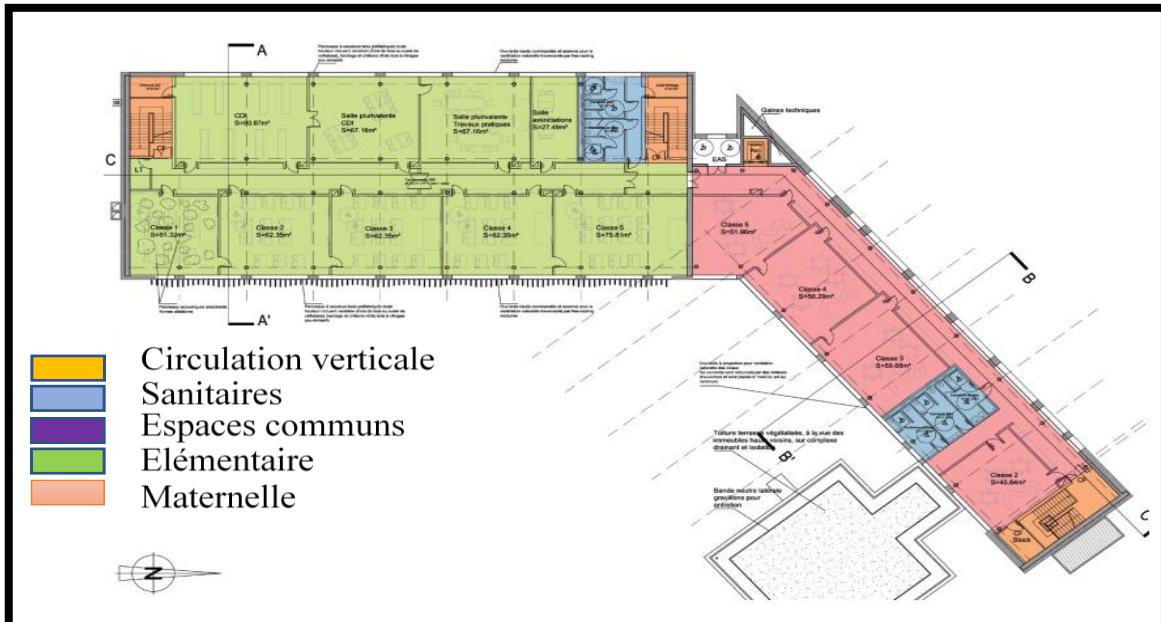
plan de RDC ⁷⁵ (traité par l'auteur)
